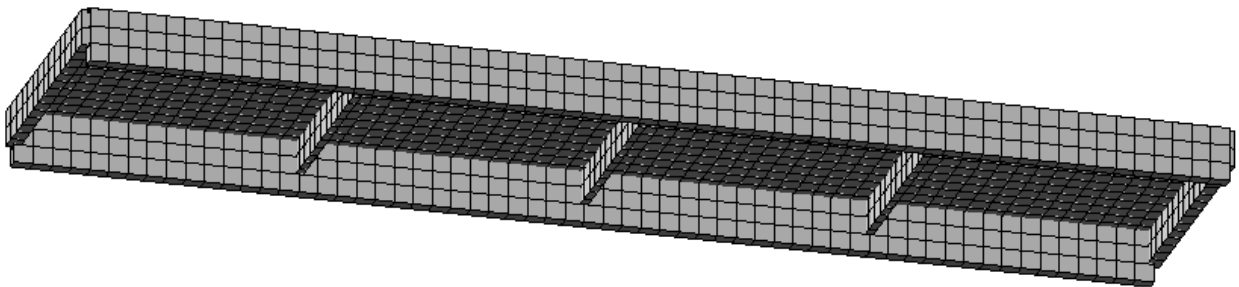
Плита перекрытия ПКЖ1 (типовой проект) в ПК Лира САПР
